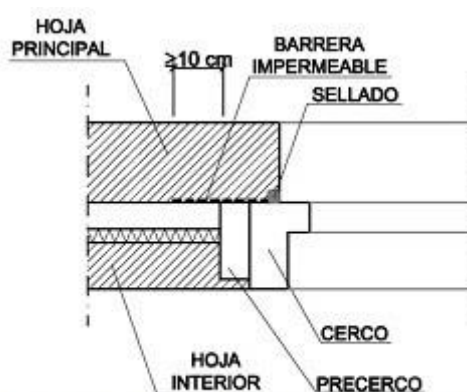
Ejemplo de encuentro de la fachada con la carpintería
